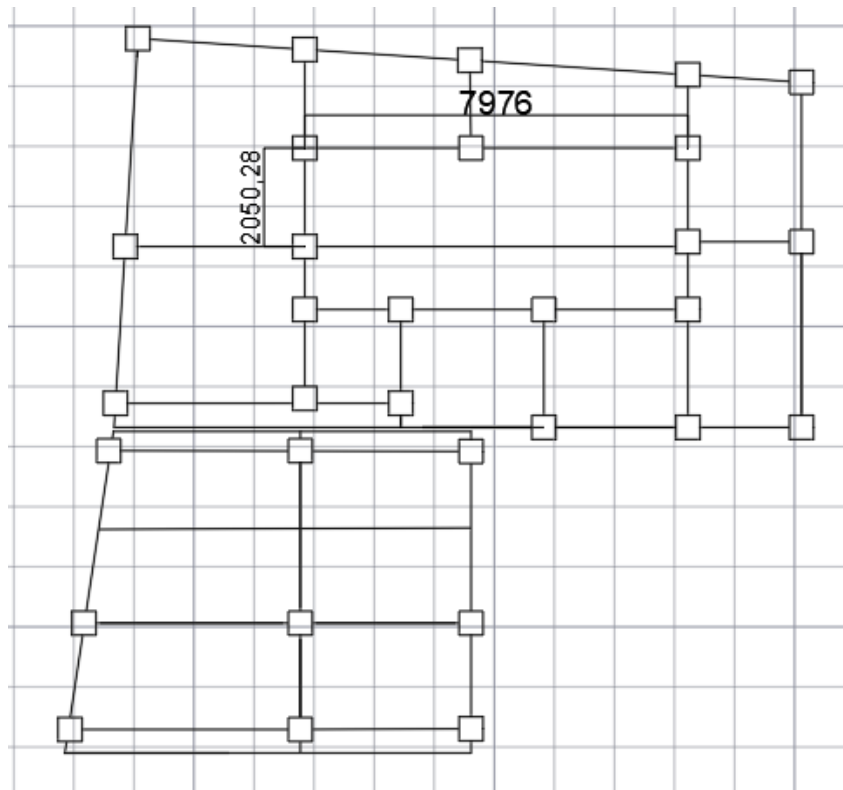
Hasil Desain Dimensi Balok Bangunan B
